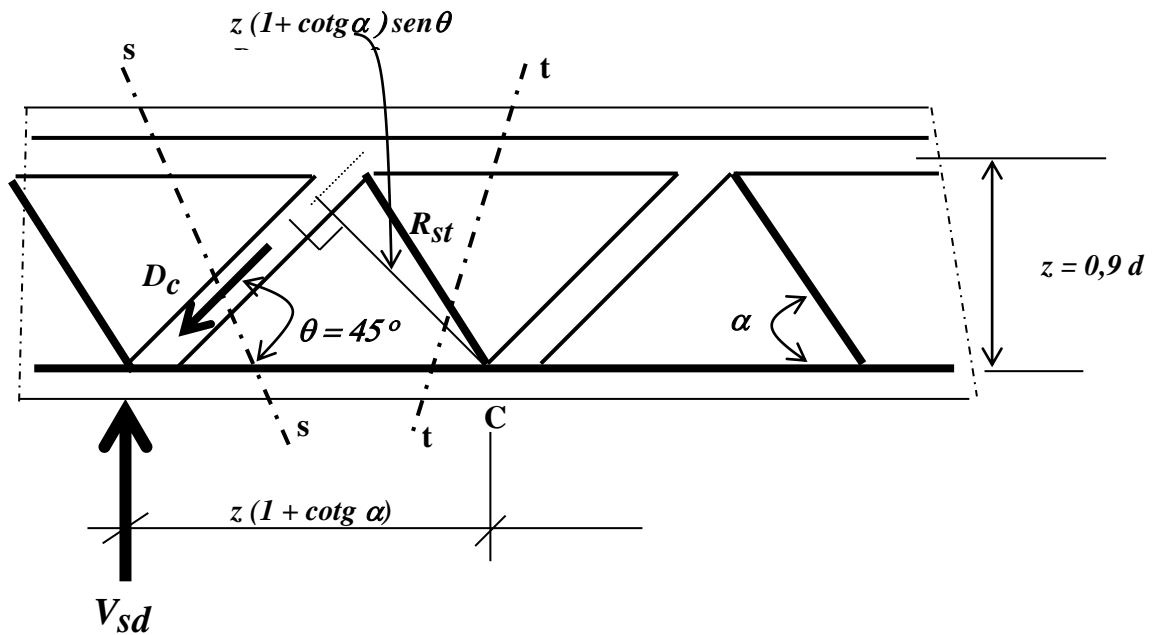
Treliça clássica de Morsch em vigas de concreto armado.
